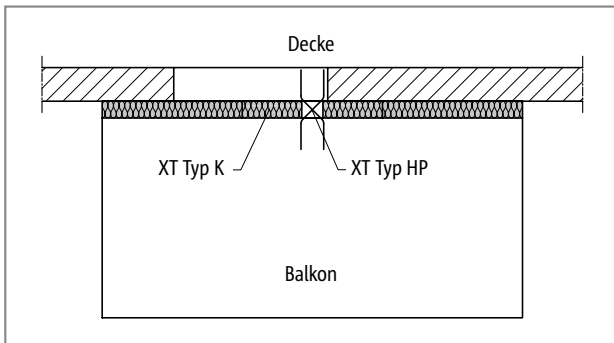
Schöck Isokorb® XT Typ K: Balkon frei auskragend; optional mit XT Typ HP bei planmäßigen Horizontallasten (z. B. geschlossene Brüstungen)
